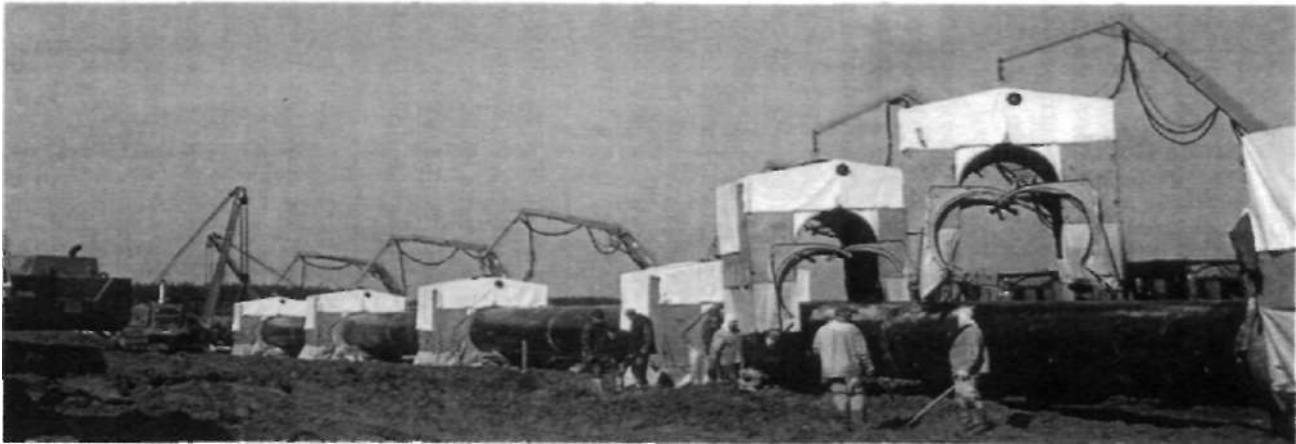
Колонна автоматической сварки CRC-Evans
